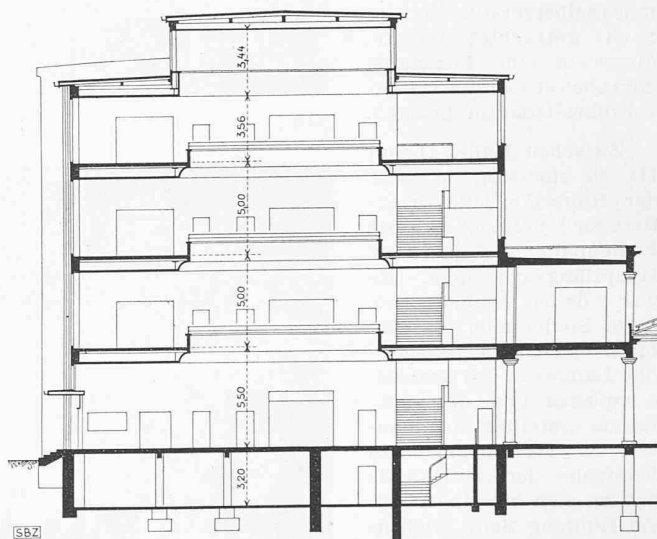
Schnitt durch den Mittelbau, Masstab 1 : 400
